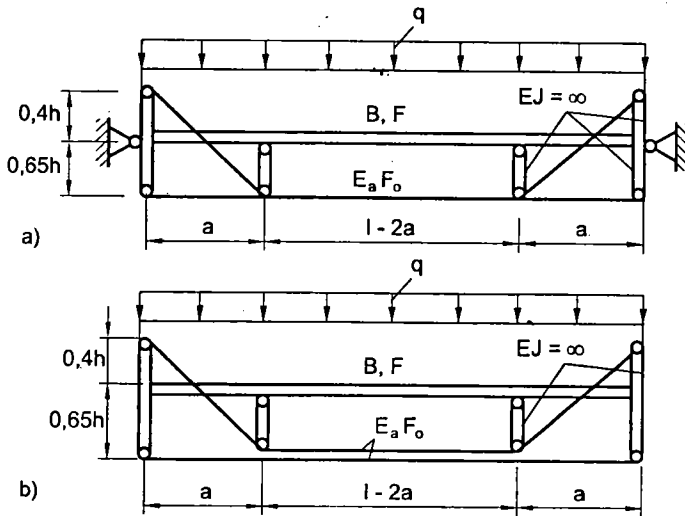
Sơ đồ tính toán gia cố bằng hệ thống dây căng tổ hợp
